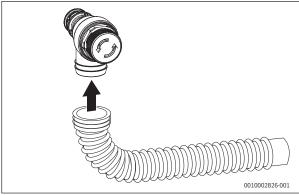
Montage du tube sur la soupape de sécurité (chauffage)
